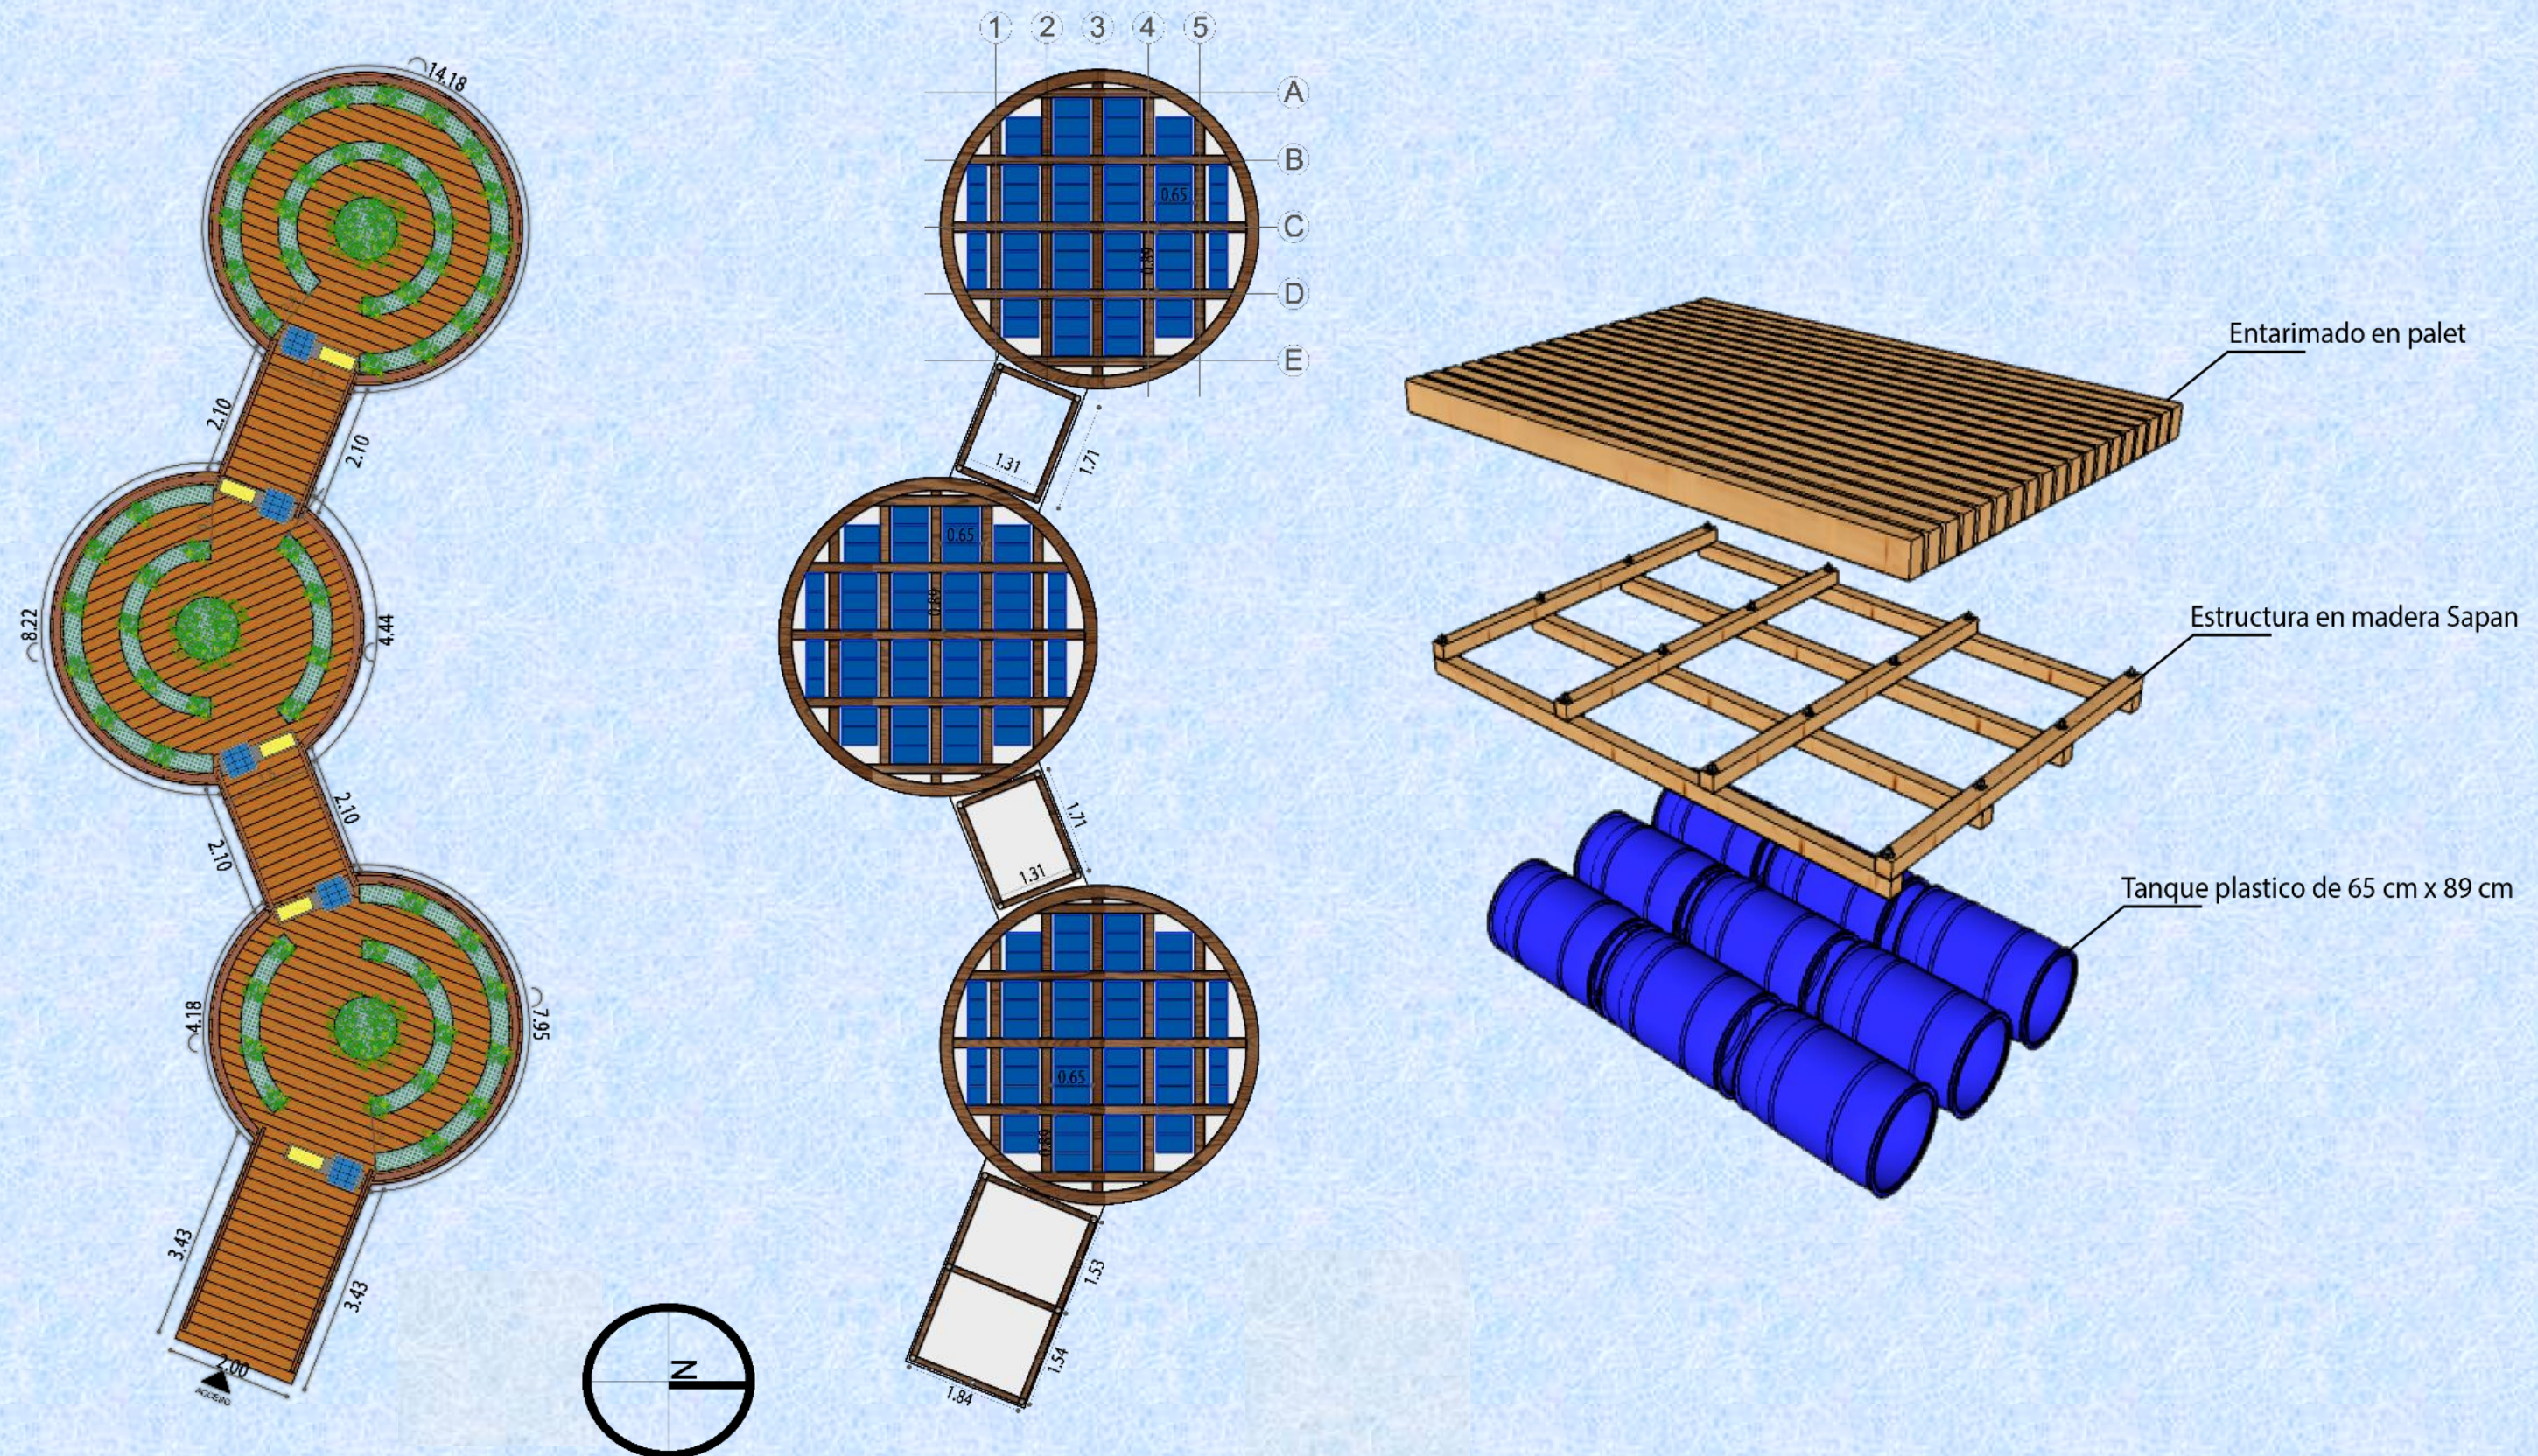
Planta general, planta estructural y detalle estructural cultivo de mangle. Fuente: Elaboración propia
